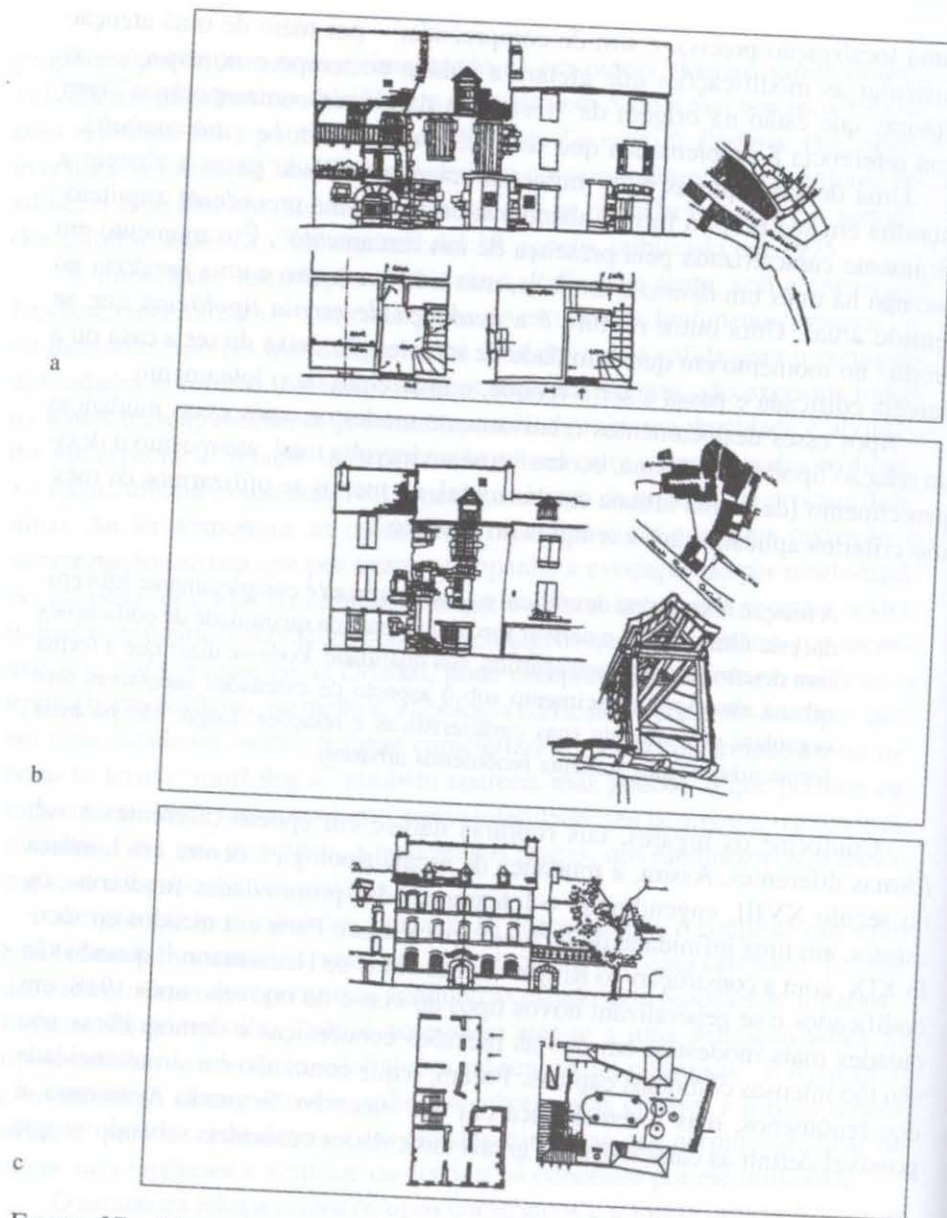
Tipos e codificação: as fachadas (Marcillac, Aveyron)
